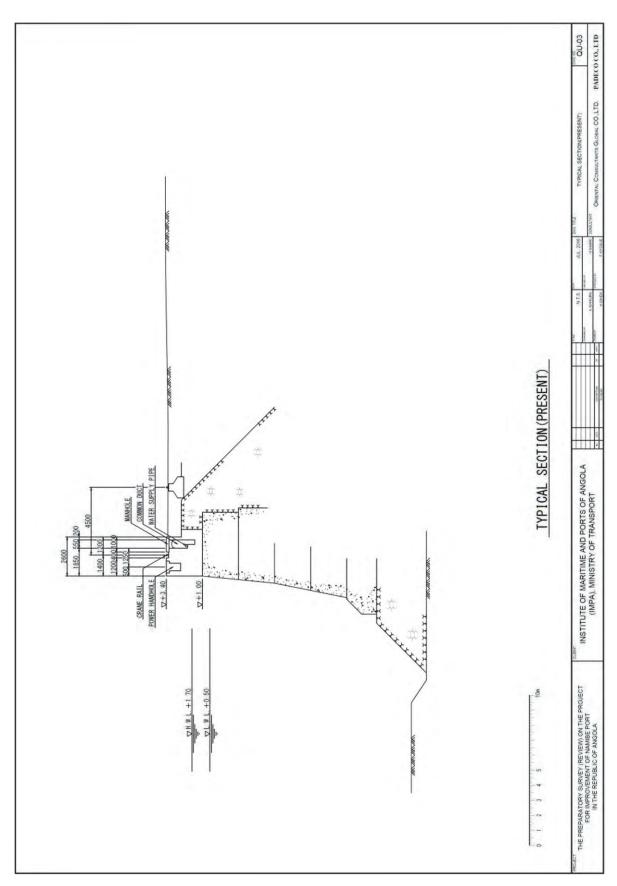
Corte-Padrão do Muro da Zona 3B (Condições Actuais)
